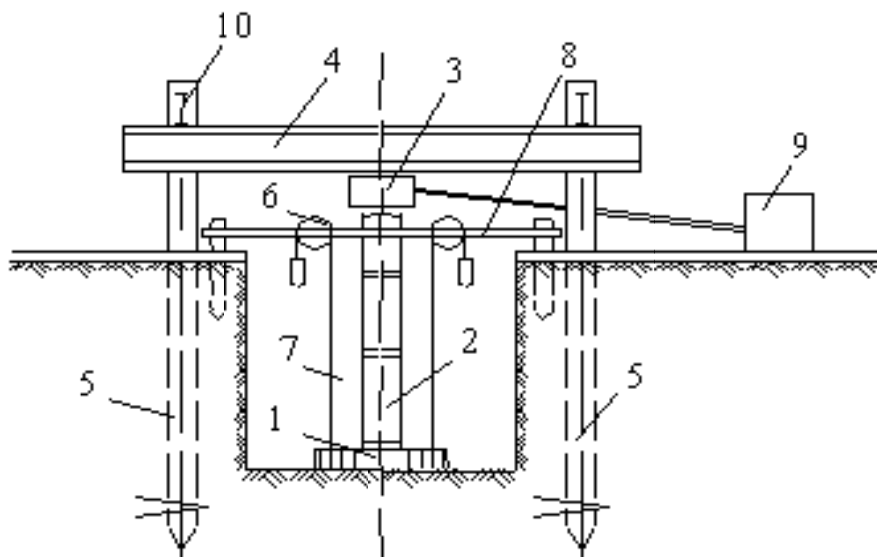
Схема испытания грунта штампом в шурфе:
